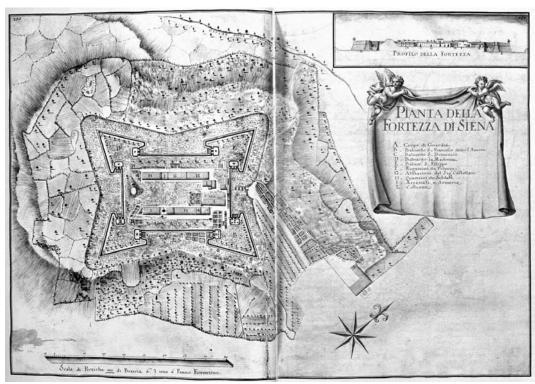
O. Warren, Pianta della Fortezza di Siena, 1749 (de Warren [1749] 1979)
